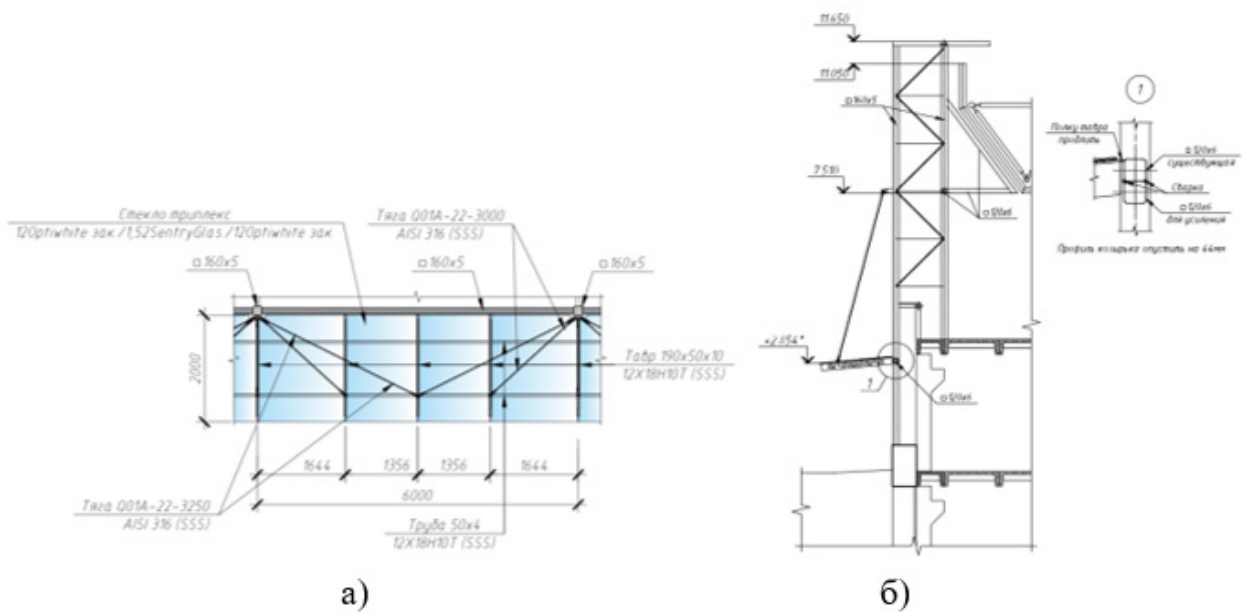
Конструктивное решение: а) Вид в плане; б) Разрез
